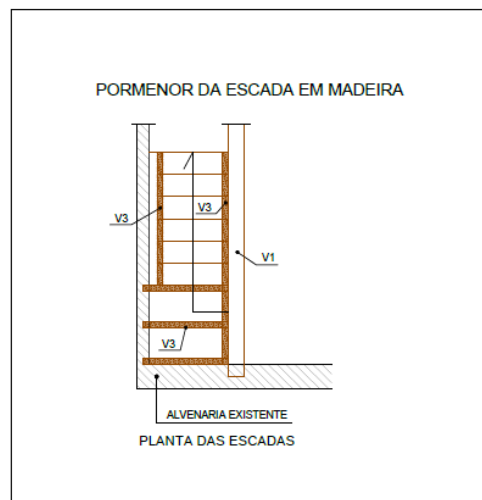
Pormenor da Escada em Madeira da Mezzanine
